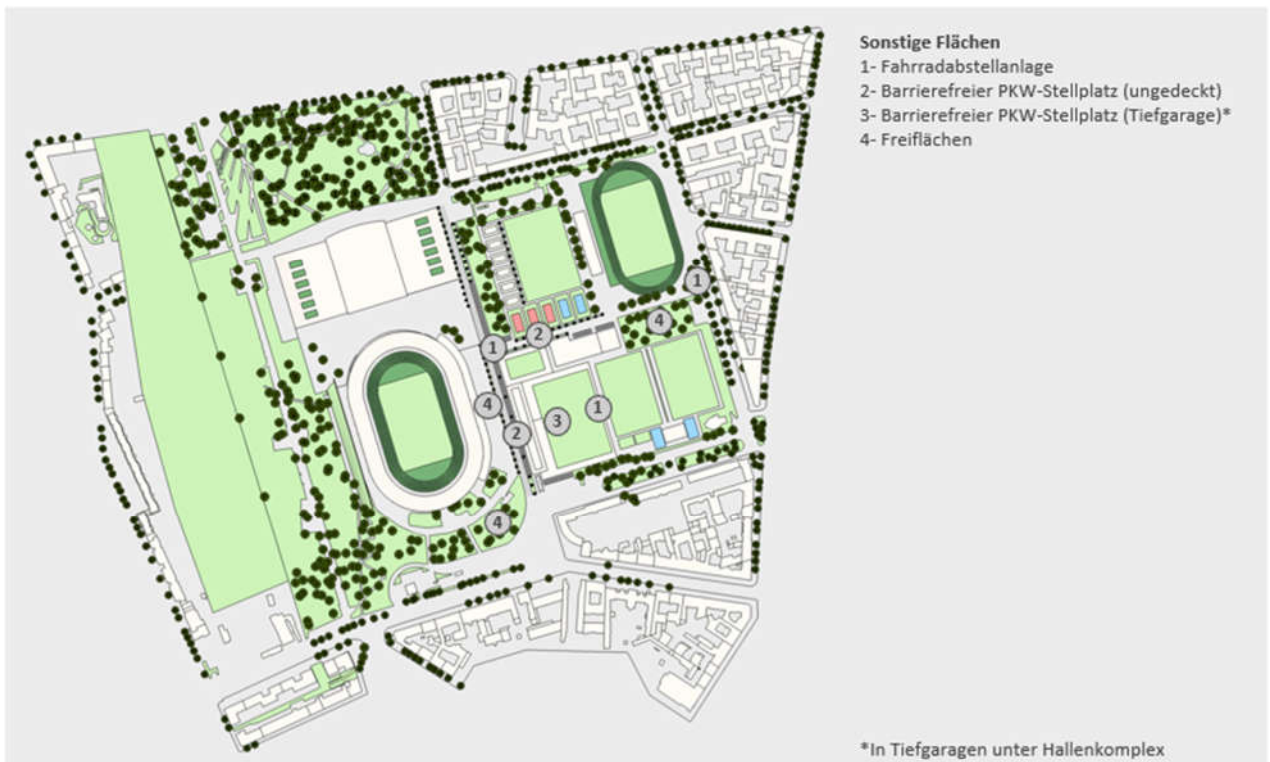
Lageplankonzeption Variante 2 - Verwaltung und Gastronomie, Sonstige Flächen
